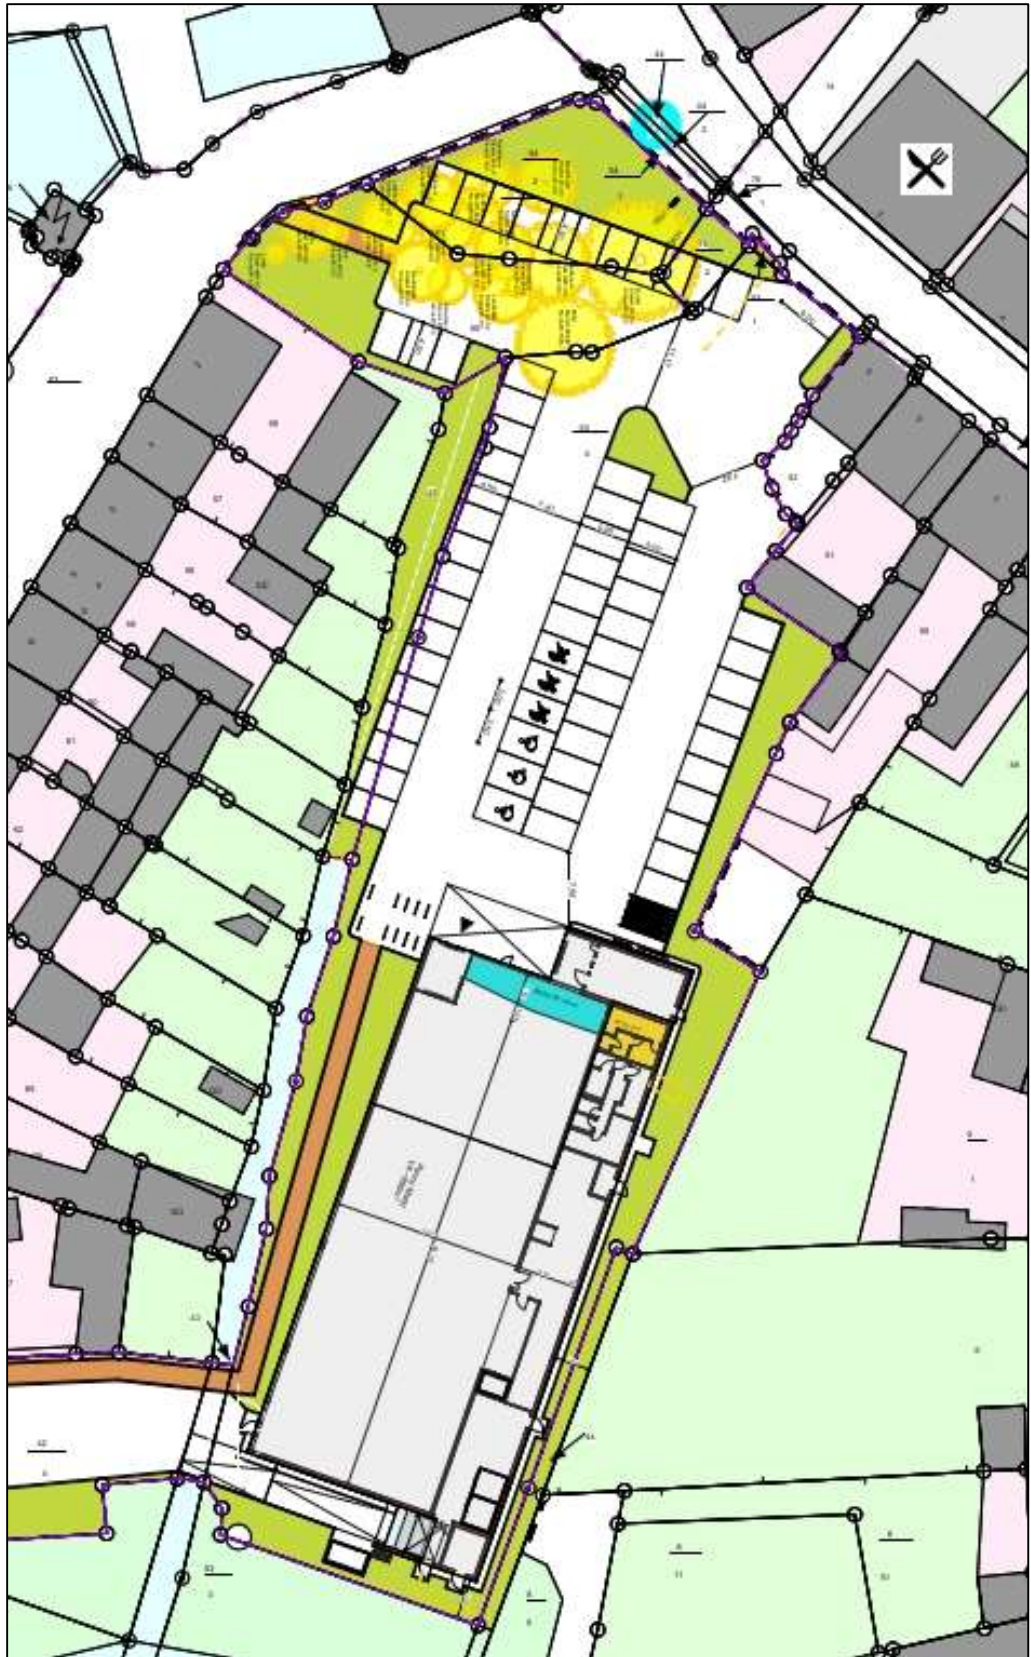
B-Plan des zukünftigen Penny-Neubaus
